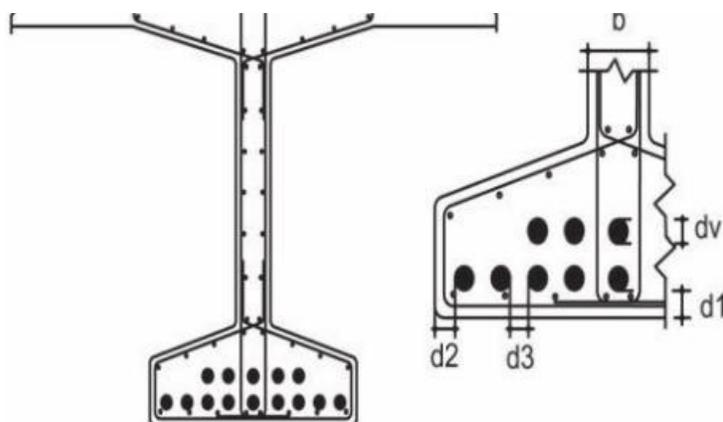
Detalle en Obra de Sección de Viga postensada de concreto Armado Puente el Pindal
